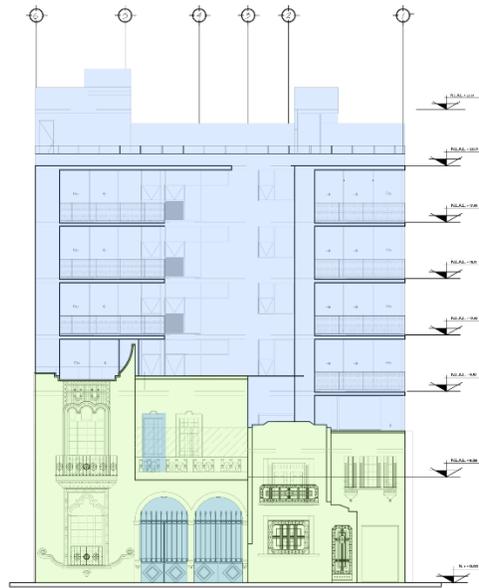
Croquis de Fachada del Edificio Lerma 76. Elaborado por Paola Morales
